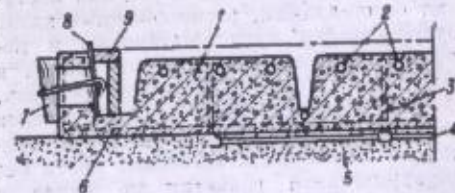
Железобетонная матрица для изготовления ребристых плит: 1 — железобетонная матрица; 2 — подогревательный регистр; 3 — выталкиватель; 4 — подводка напорной воды или сжатого воздуха и выталкиватель; 5 — песчаная подушка; 6 — арматура матрицы; 7 — вилы для крепления борта; 8 — металлическая пластина; 9 — закладной борт.
